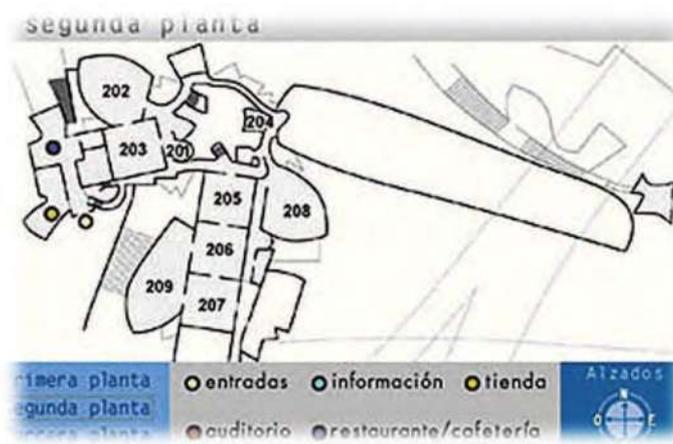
Guggenheim de Bilbao, planta arquitectónica 1.
